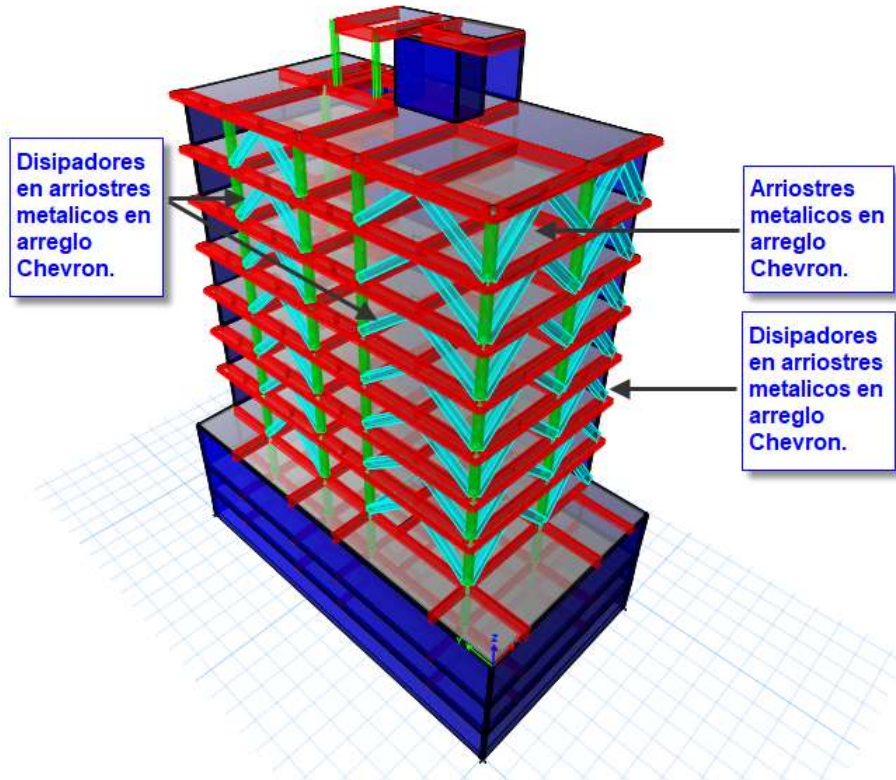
Vista en elevación en la dirección del eje Y con disipadores metálicos SLB.
